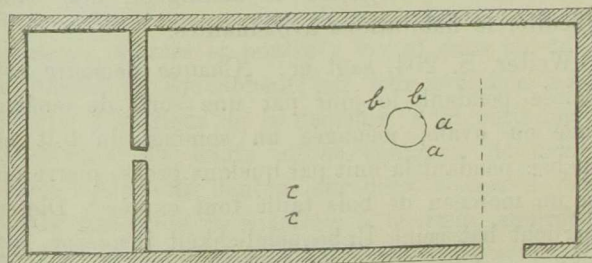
Grundriss eines armenischen Bauernhauses mit Angabe der gewöhnlichen Sitzordnung.
